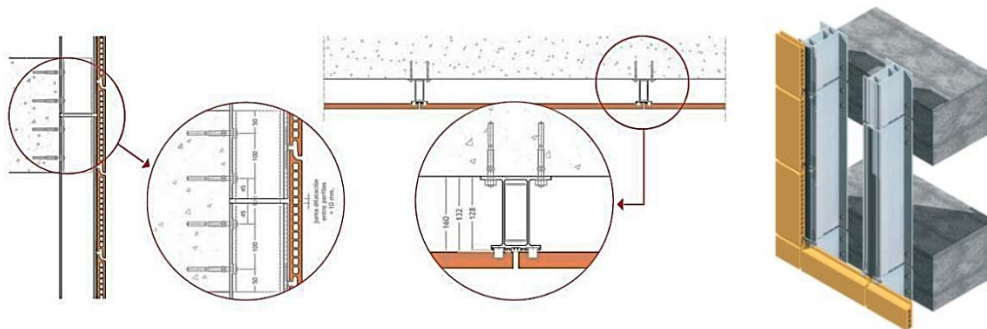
Ejemplo de esquema constructivo de fachada ventilada ligera de hoja exterior colgada mediante soportes entre forjados
